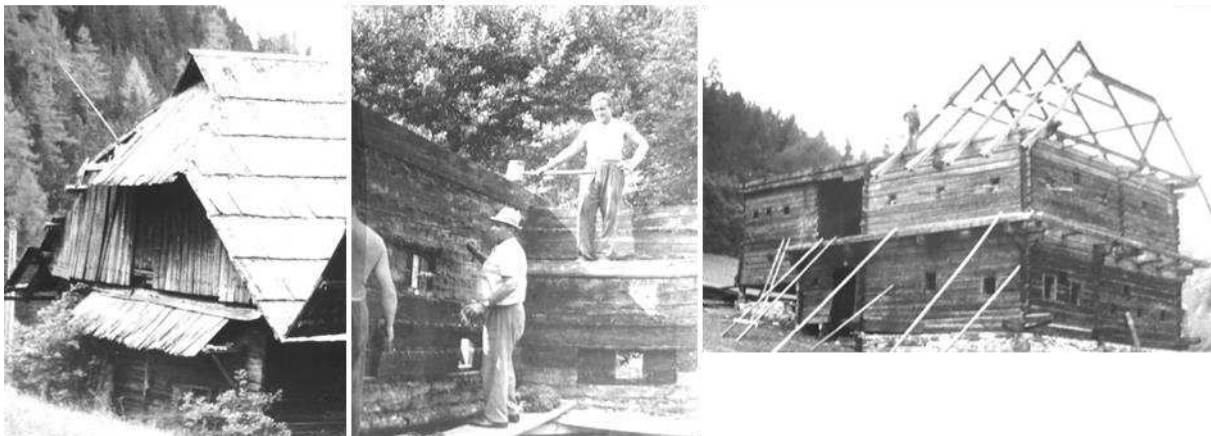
Dachansicht mit Ansatzlücke (Archiv ÖFLM Stübing, 1968)
